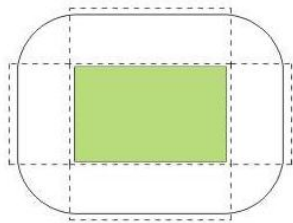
planimetria horizontal das arquibancadas para o exemplar de São Paulo
